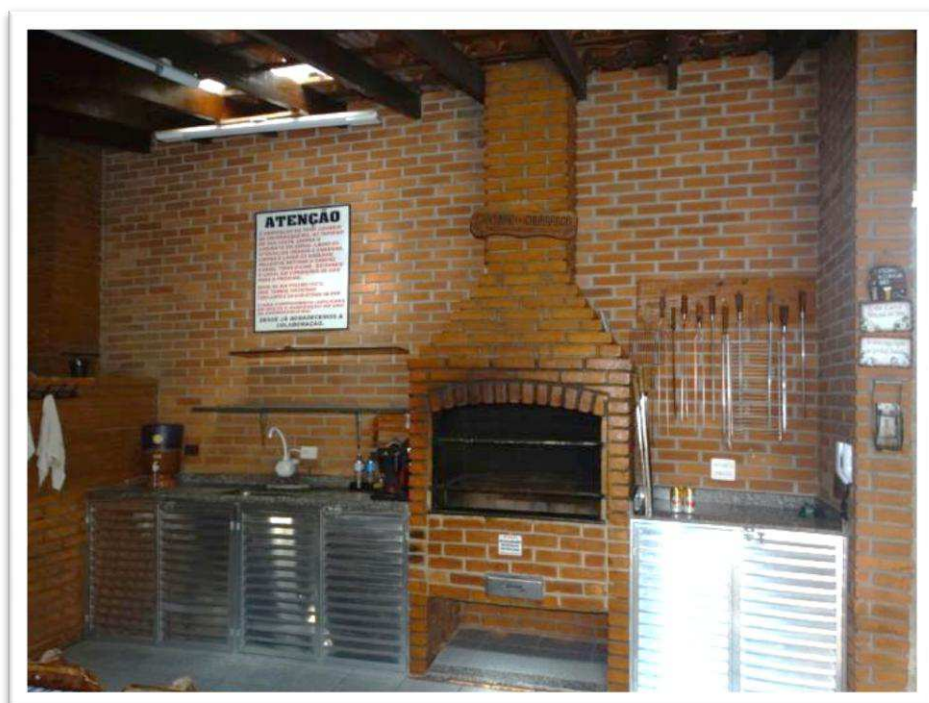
Vista parcial da área de lazer no pavimento térreo do bloco 17 – Churrasqueira.
